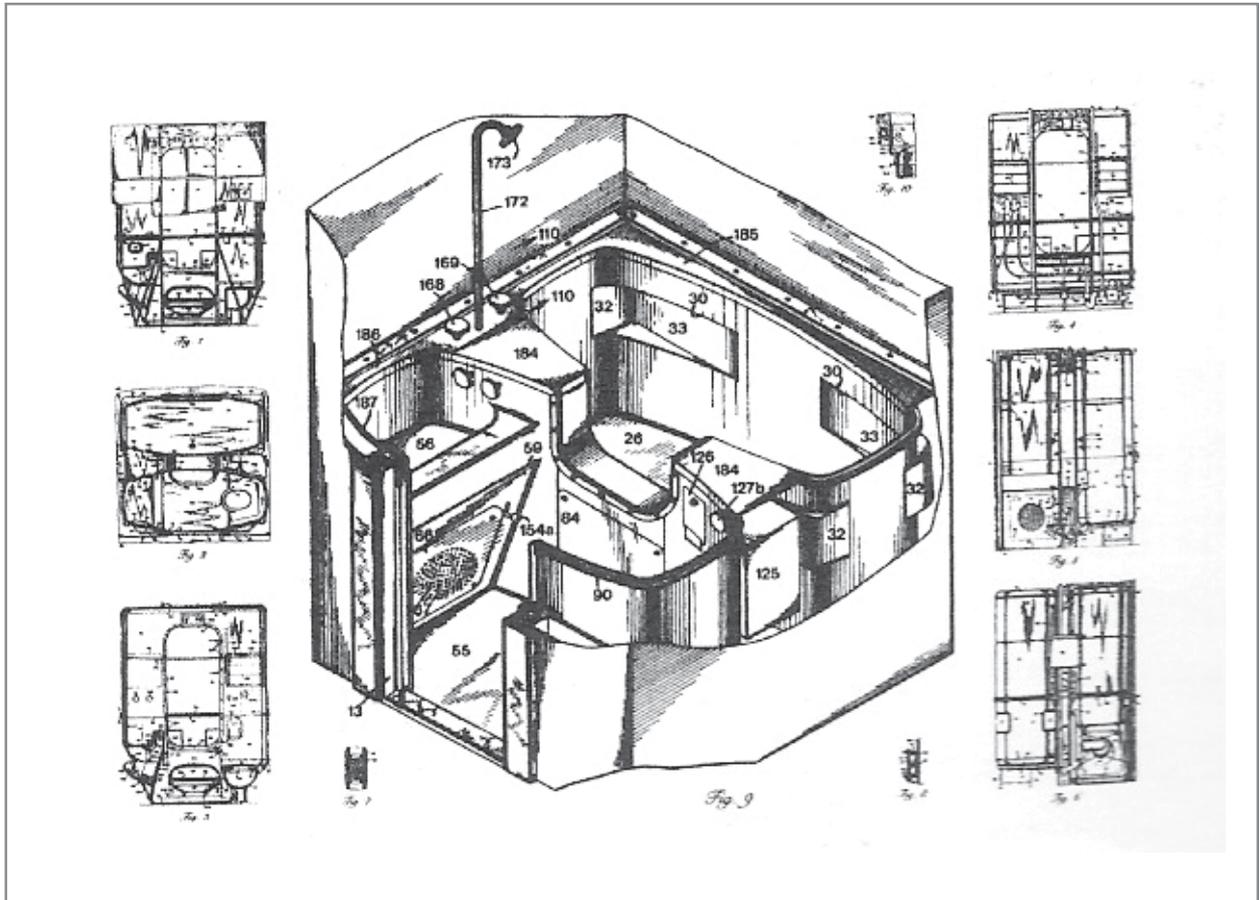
Módulo pré-fabricado de um sanitário, 1938, Fuller.
